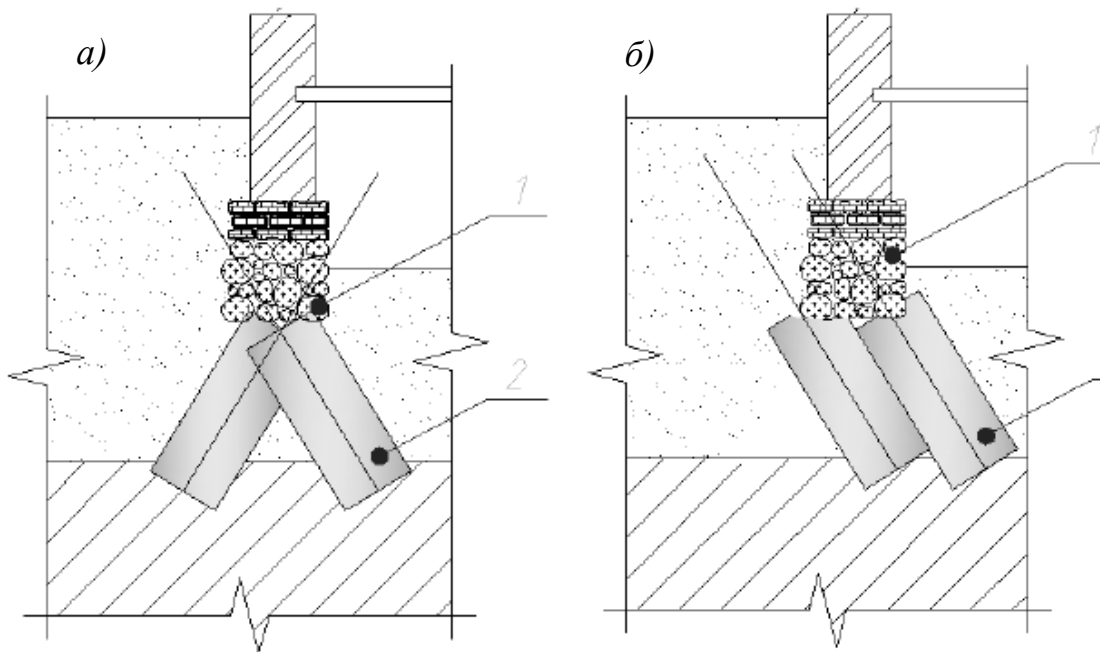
Схема усиления грунтов в основании ленточных фундаментов:
